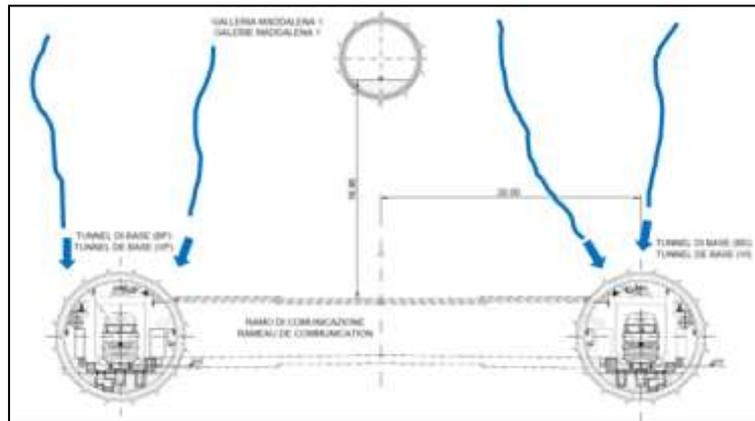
Sezione trasversale di Maddalena 1 con il Tunnel di Base
